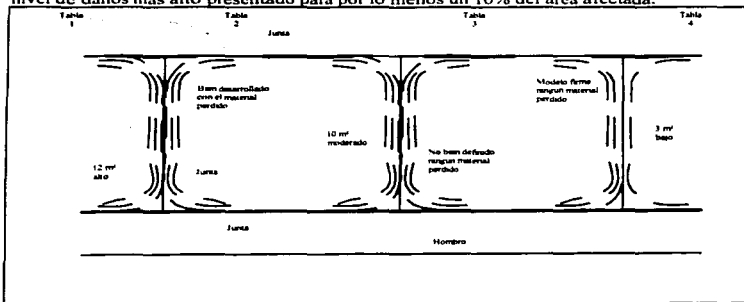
Grietas por estabilidad (grietas "D").
